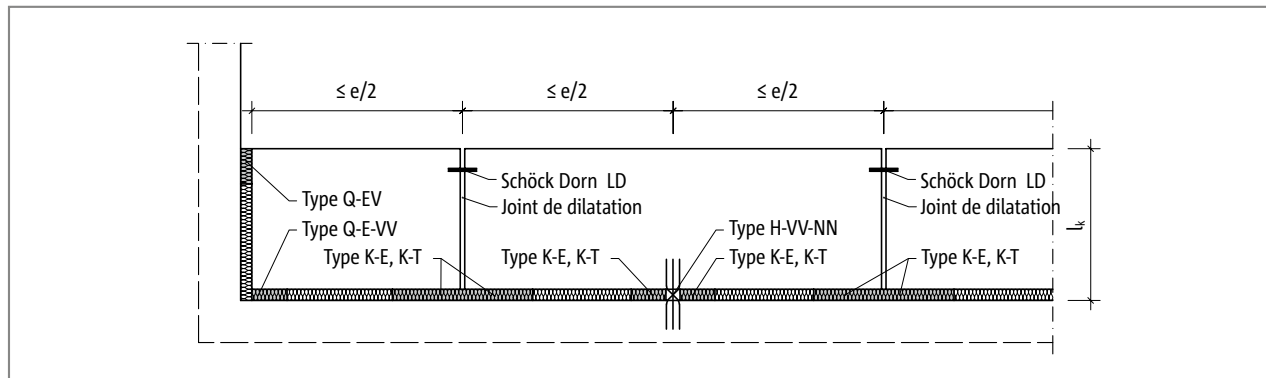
Schöck Isokorb® T Type H : Disposition des joints de dilatation
